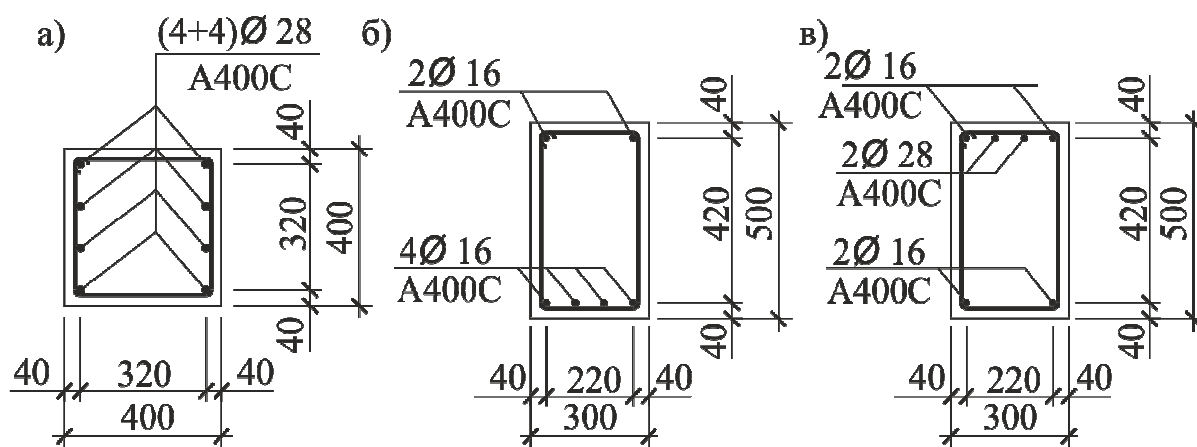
Армирование элементов железобетонного рамного каркаса:
